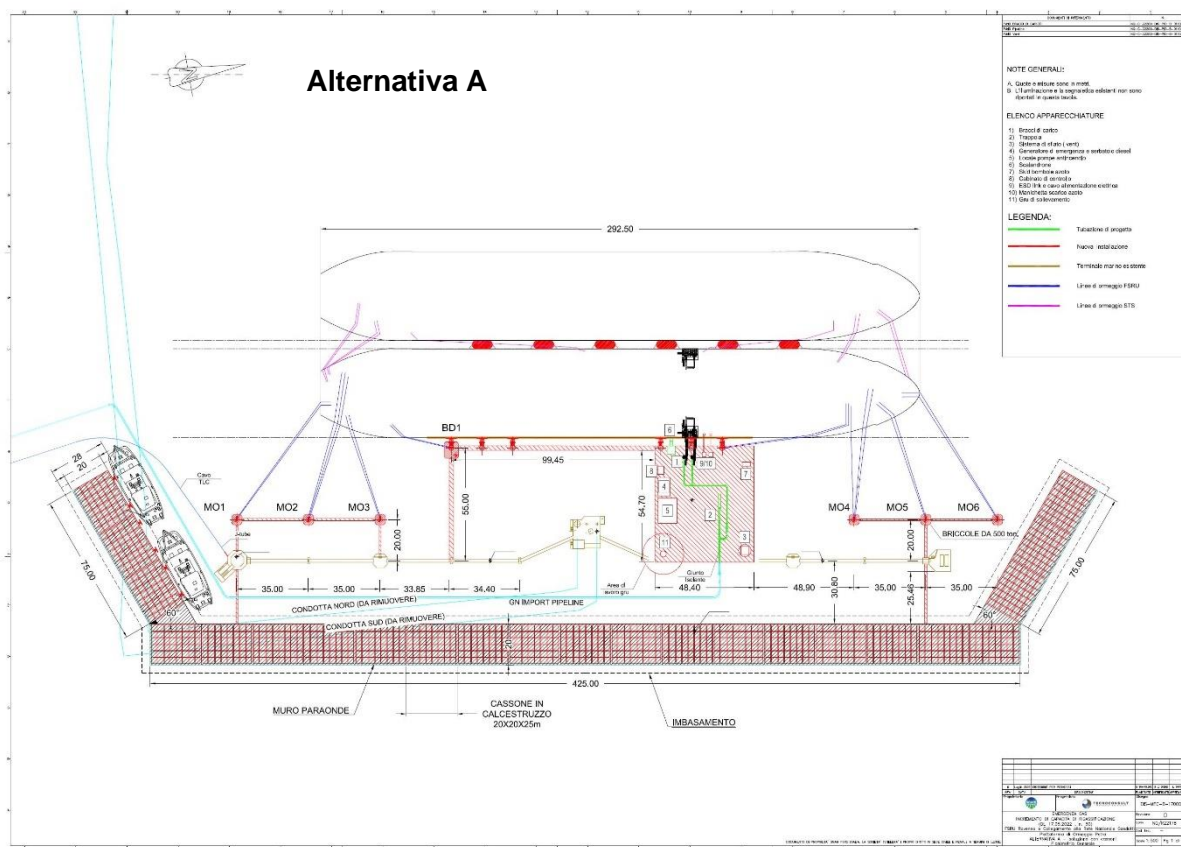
Layout di progetto Alternativa A [Rif. 1]
